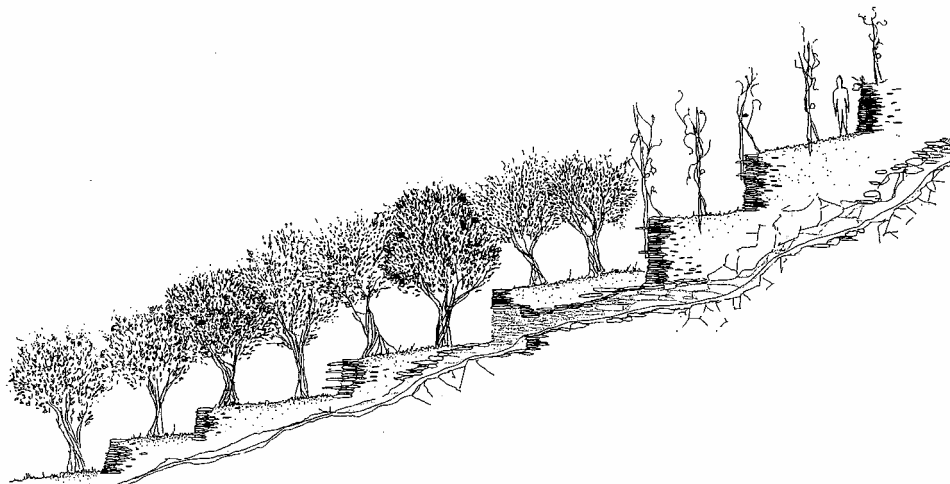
Esempio schematico di utilizzo di muretti a secco nella stabilizzazione della coltre detritica di un versante tramite gradonatura (da BRANCUCCI et al., 2000) -
